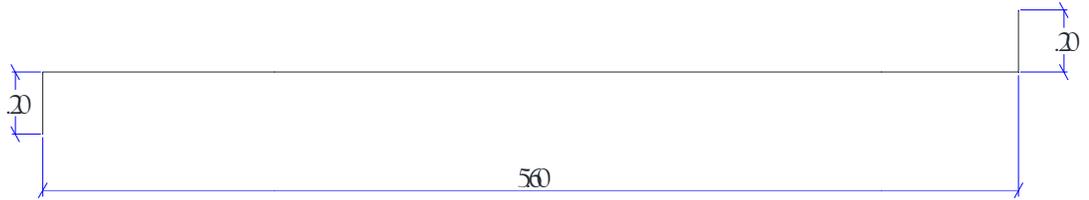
ACERO DE REFUERZO DEL VÁSTAGO DEL MURO
